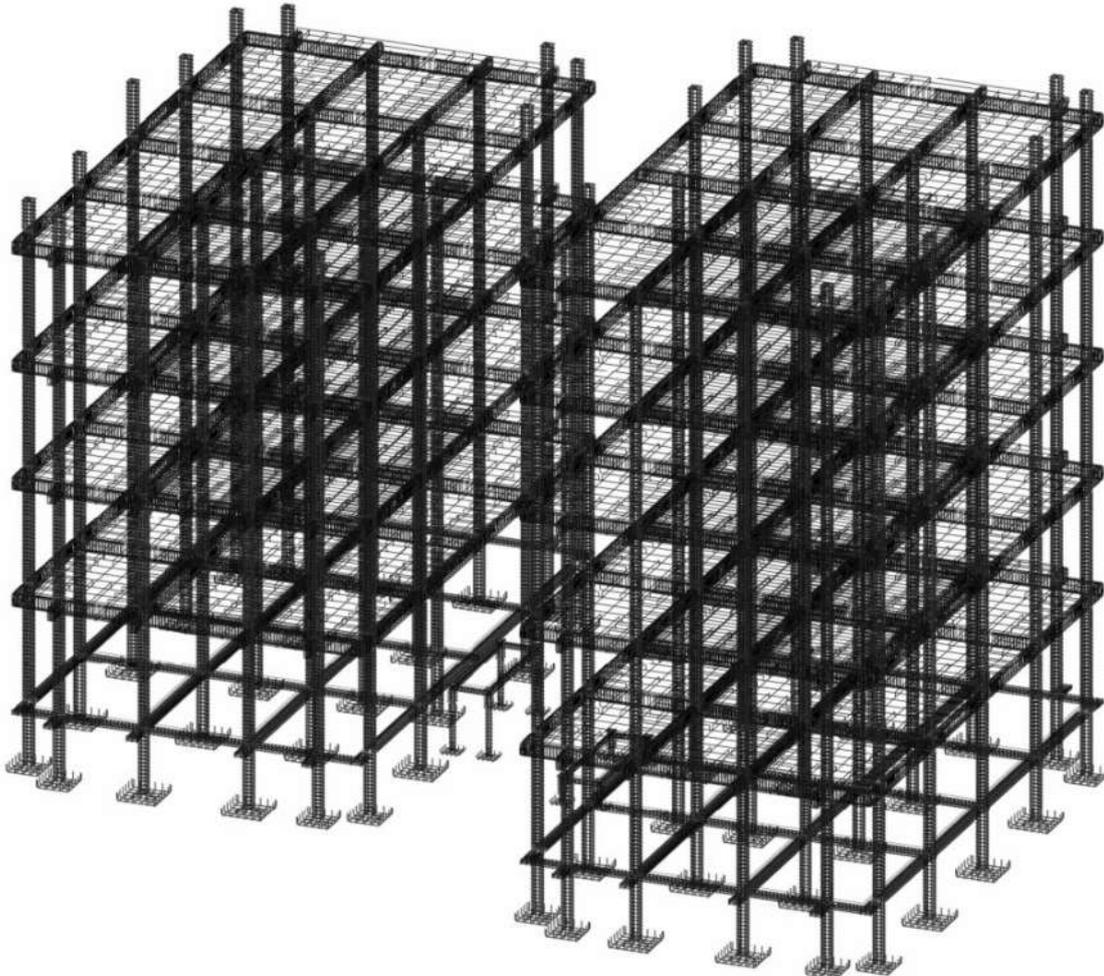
Vista 3D Armado de acero de refuerzo Estructural
